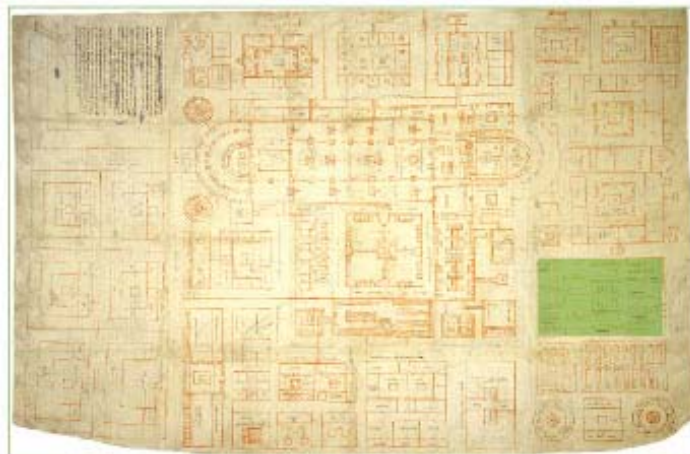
Klosterplan, Planausschnitt Obstgarten/Friedhof
